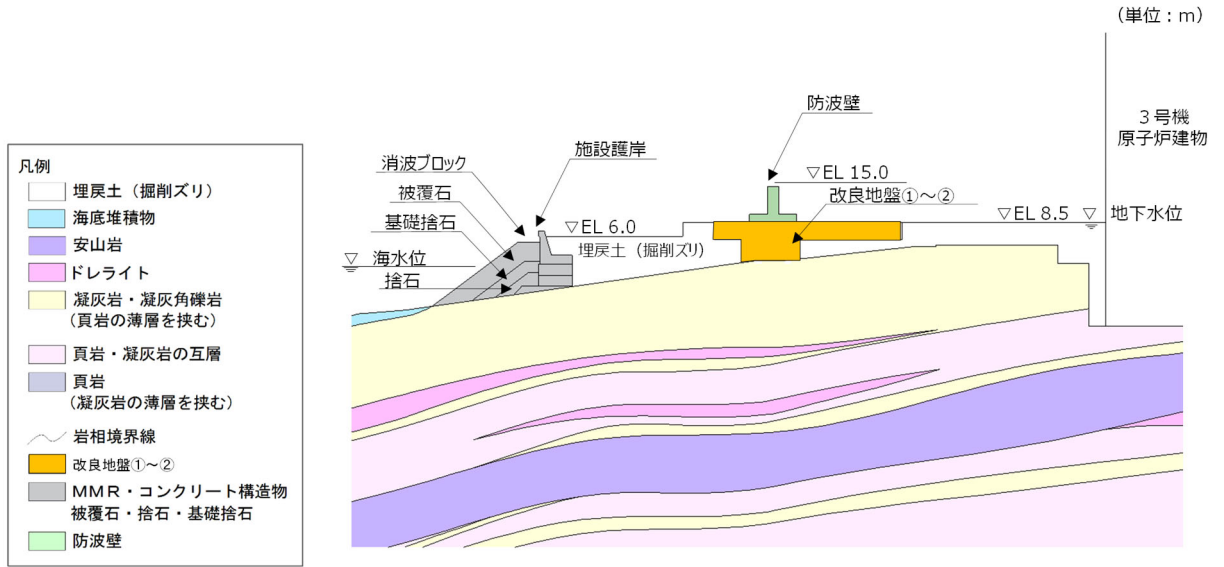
防波壁 (逆 T 擁壁) の横断面図 (③-③断面)
